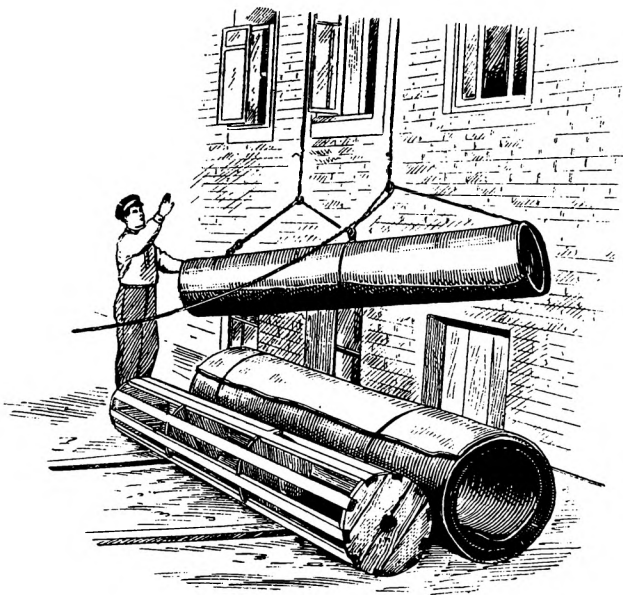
Подъем рулона сварной кровли на крышу здания
